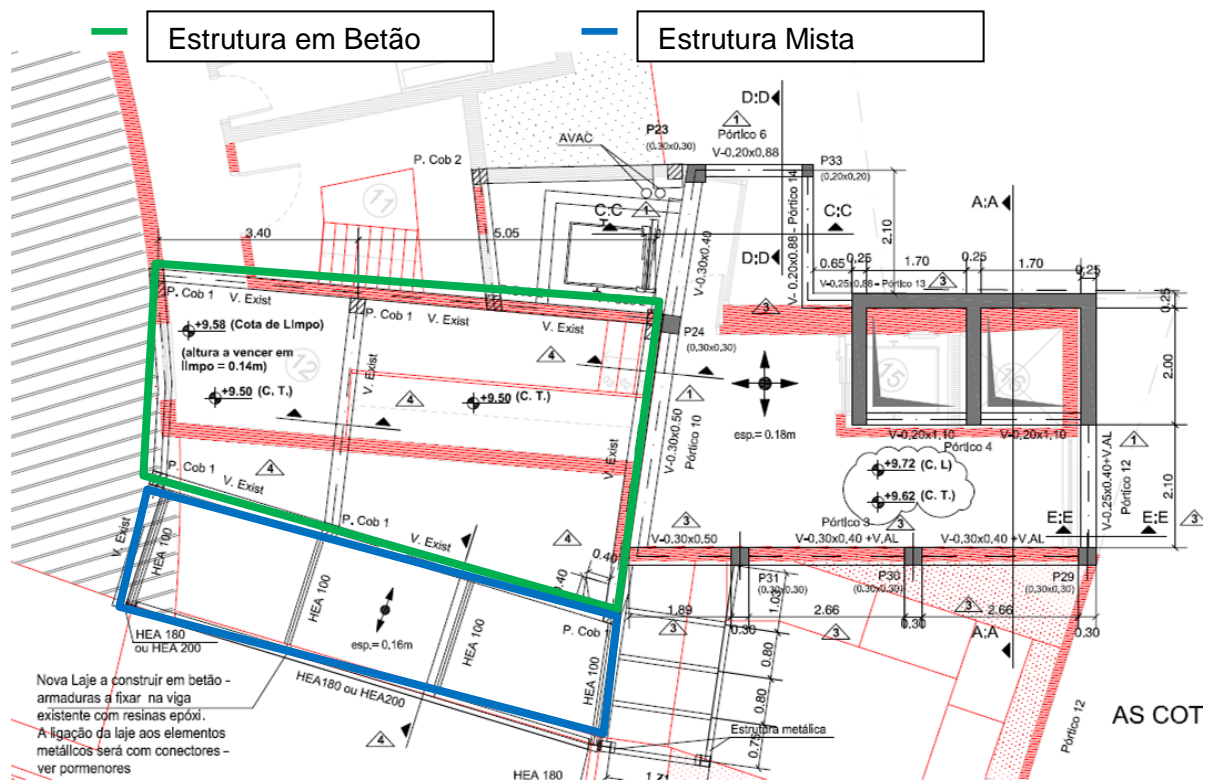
Planta do piso 3 - preparação dos trabalhos [AVicêncio A, 2017]
